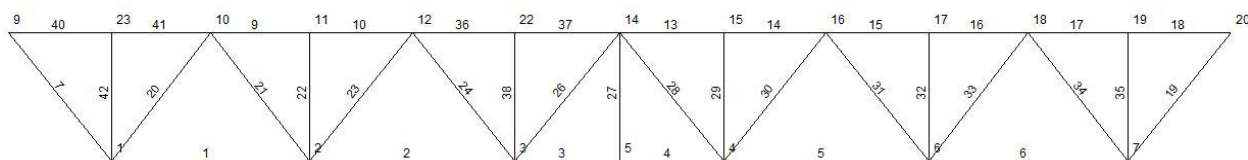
Схема обозначения номеров узлов и элементов фермы
